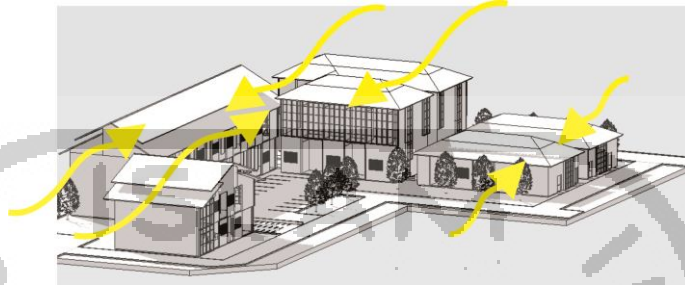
36 Bukaan yang menangkap cahaya masuk ke dalam bangunan
